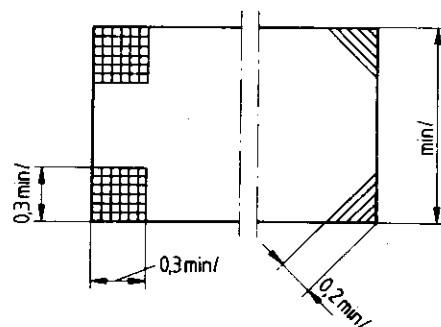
Rechtwinklige und schräge Eckbewehrung, Unterseite
